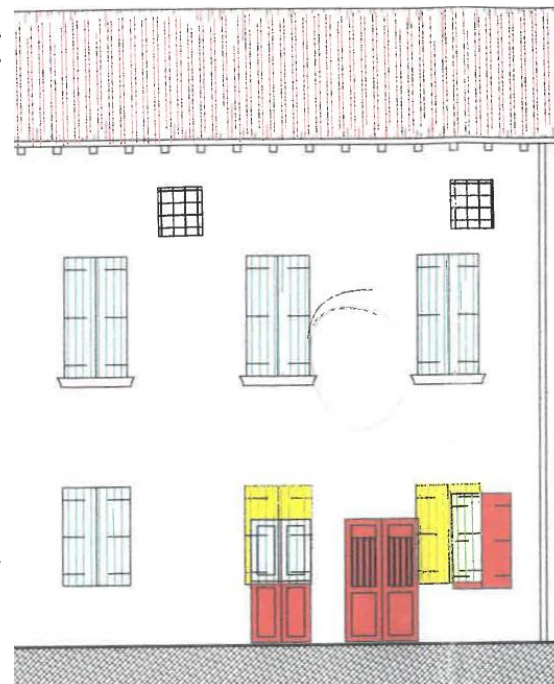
Prospetto Nord blocco D - Stato di progetto
